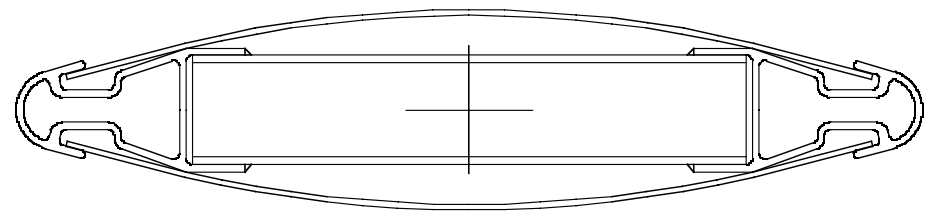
Querschnitt Holz-Alu-Lamelle mit Deckschicht aus Birkenesperrholz 2 mm
